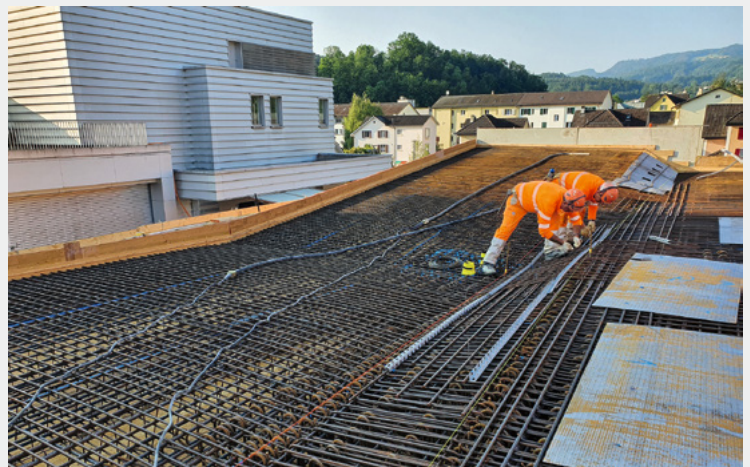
Bewehrungsmodell, Bewehrungsverlegung
